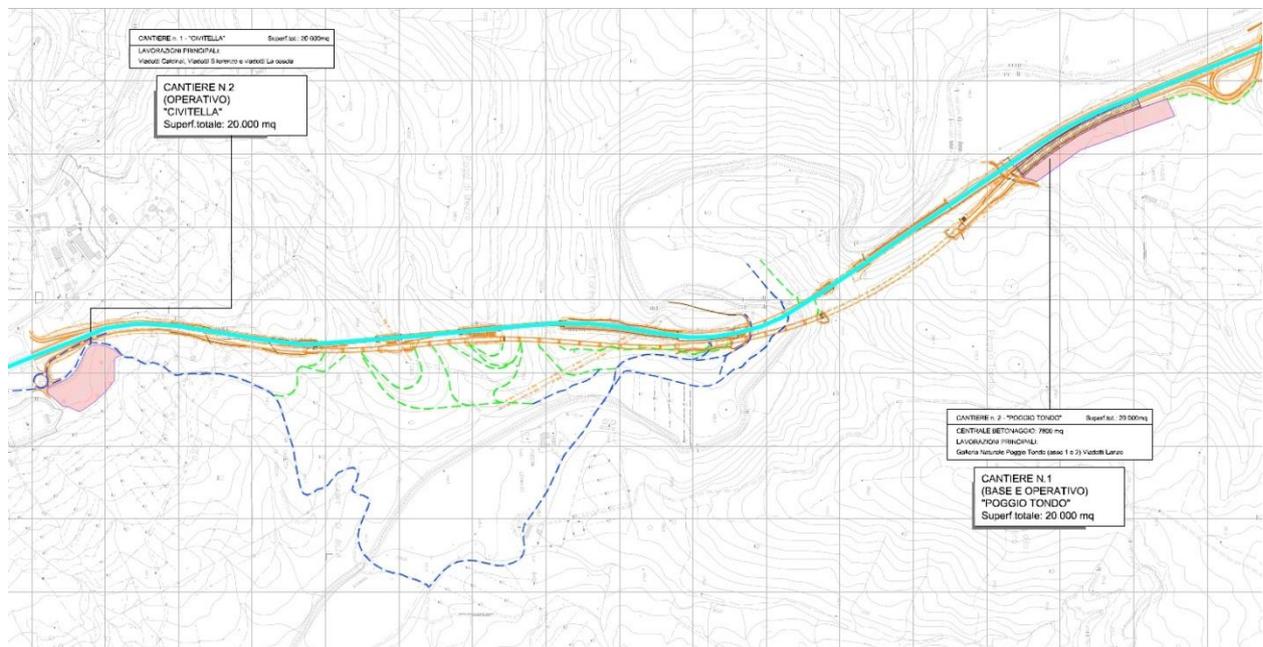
Planimetria con individuazione dei cantieri base e operativi.
